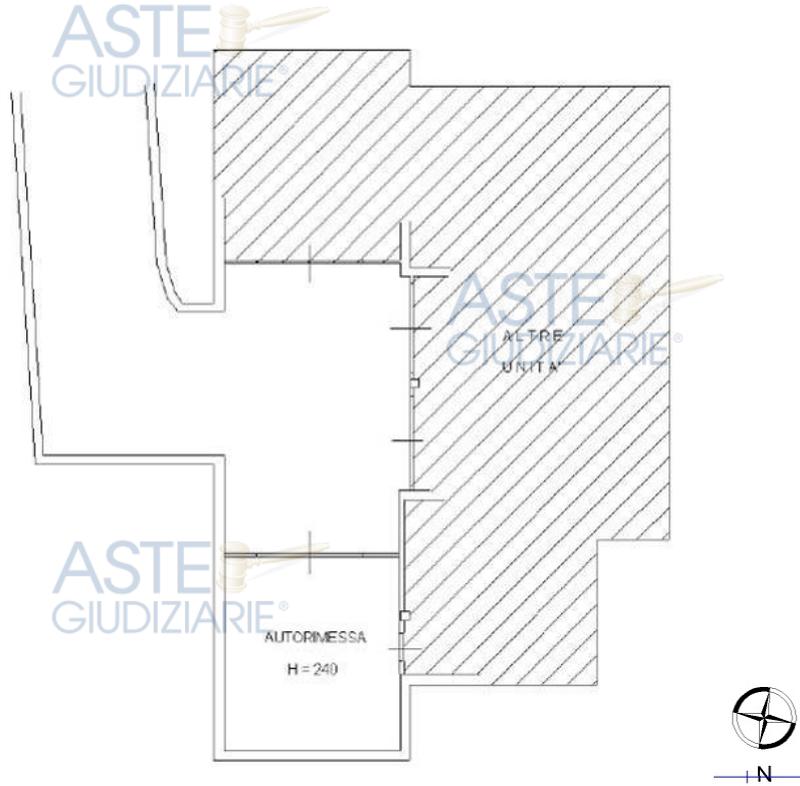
Stralcio planimetria autorimessa – NCT Fg.4 particella 370 sub. 5
